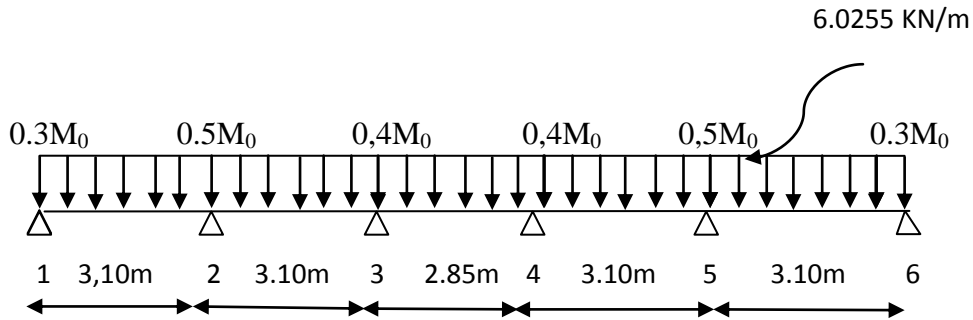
Schéma statique de la poutre continue reposant sur 06 appuis
